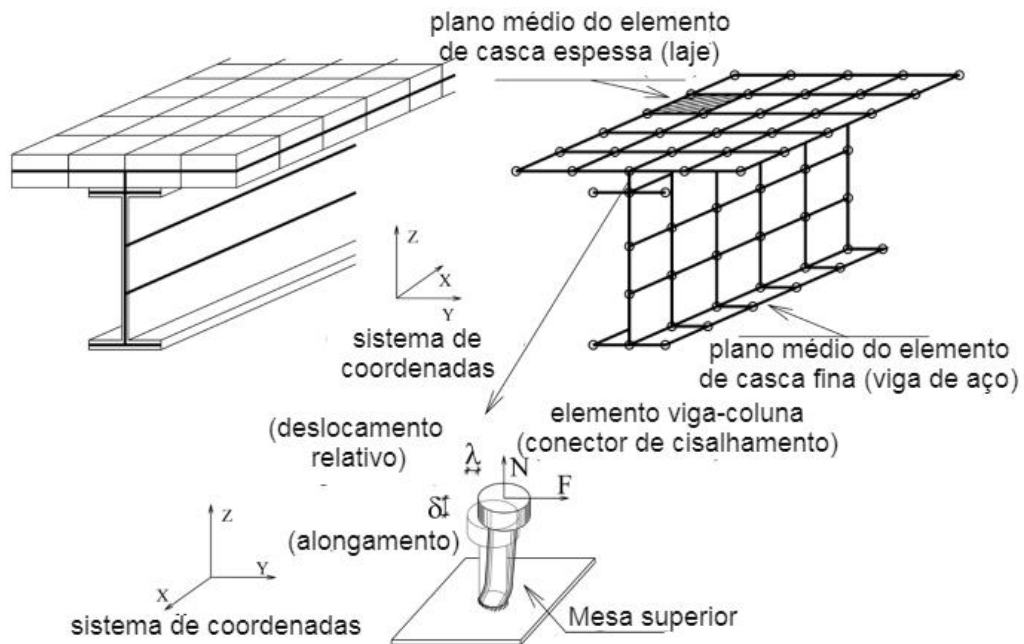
Elemento tridimensional barra viga-coluna. Modelagem dos conectores.
